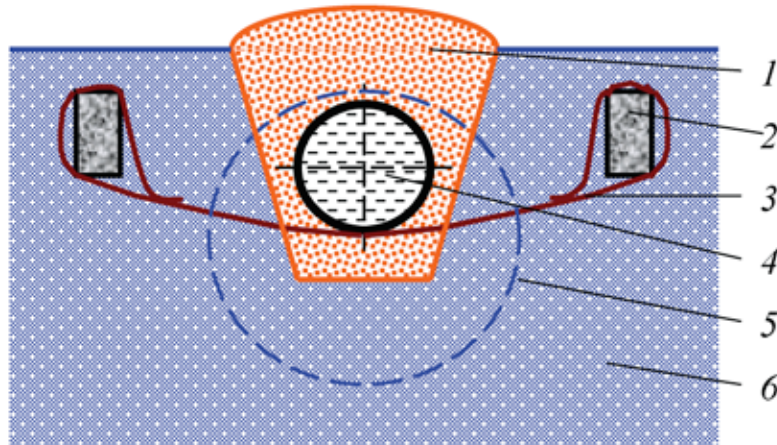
Схема укладки подземного трубопровода на гибкие опоры
